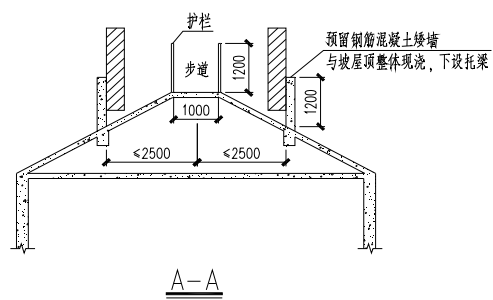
无小塔楼坡屋顶天线布置示意图
